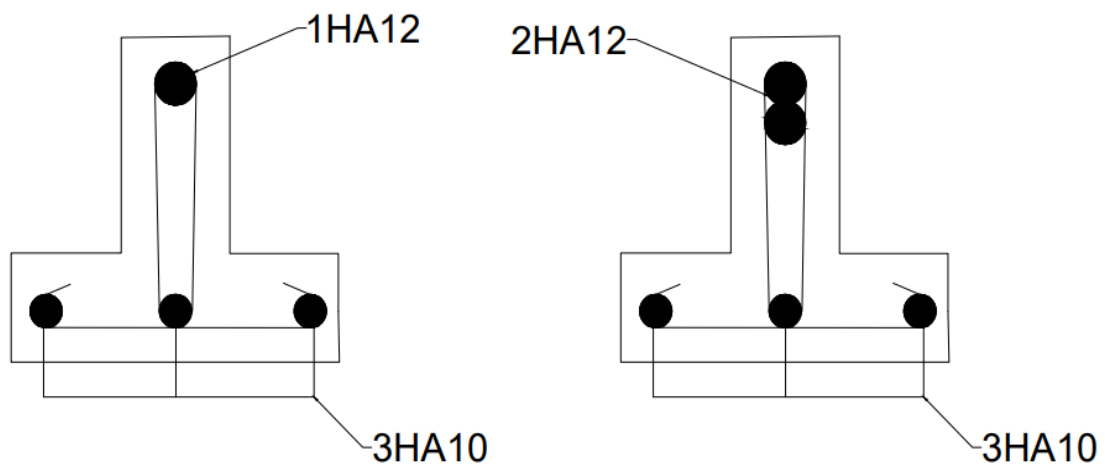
disposition des armatures dans la poutrelle (appui; travée)
